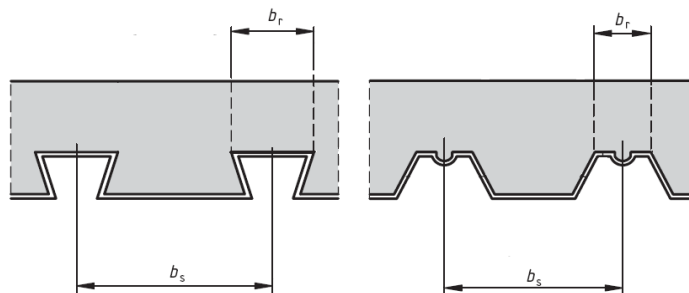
Dimensões da laje e chapa (“Eurocode 4 - Design of composite steel and concrete structures - Part 1-1: General rules and rules for buildings,” 2004).
